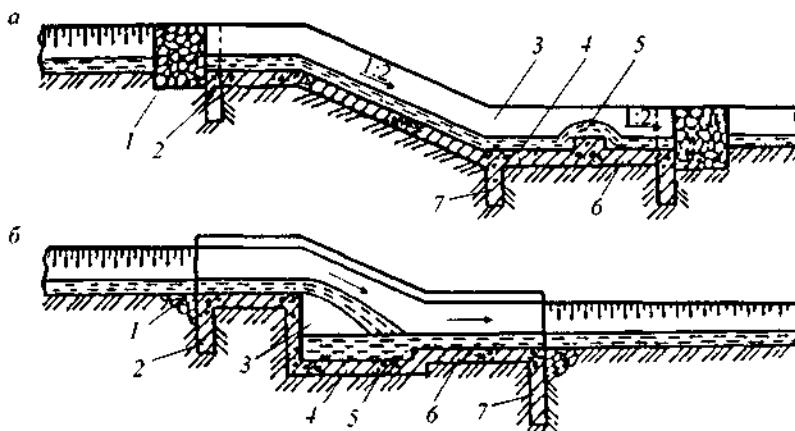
Бетонный быстроток (а) и железобетонный перепад (б): 1 — мощение камнем; 2 — шпора у входа; 3 — боковые стенки; 4 — водобойный колодец; 5 — водобойная стенка; 6 — выходной лоток; 7 — шпора у входа
